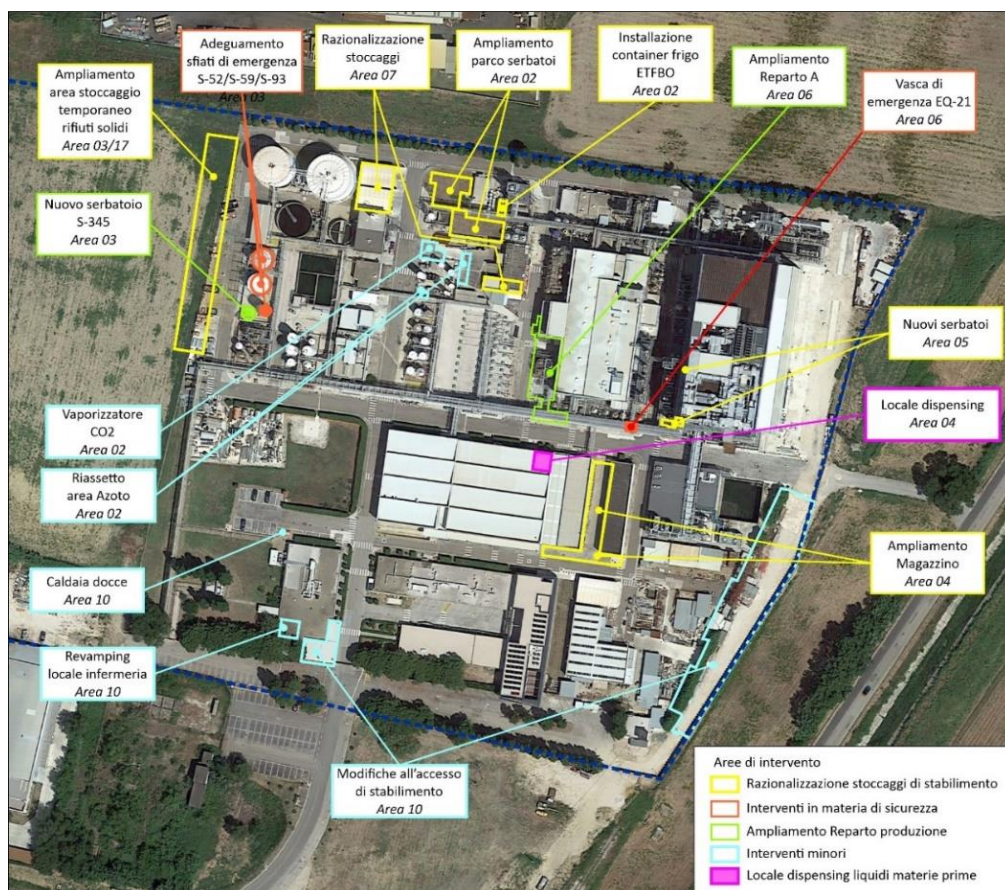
Aree interessate dalle opere previste dal progetto in esame
